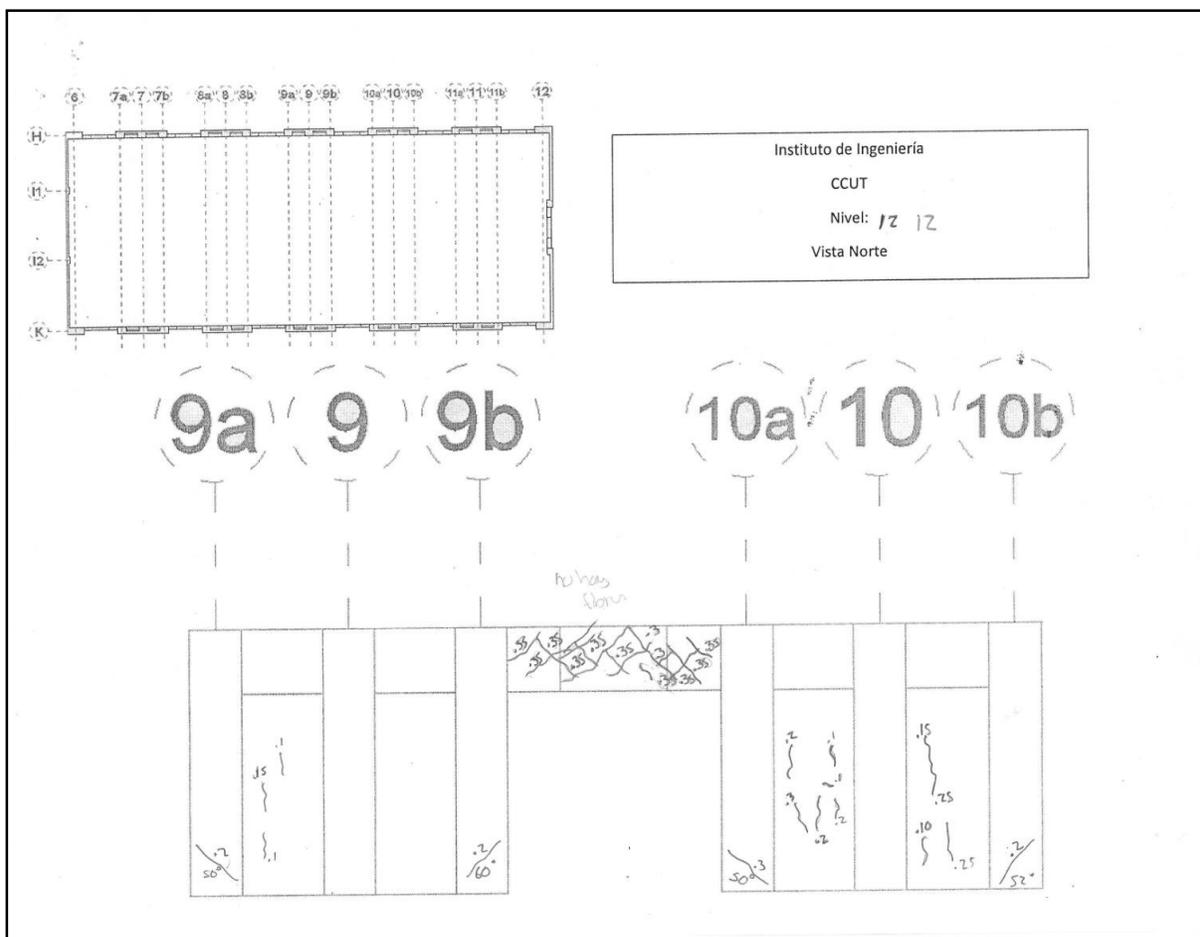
Elevación con levantamiento de grietas en columnas, muros y trabes.
